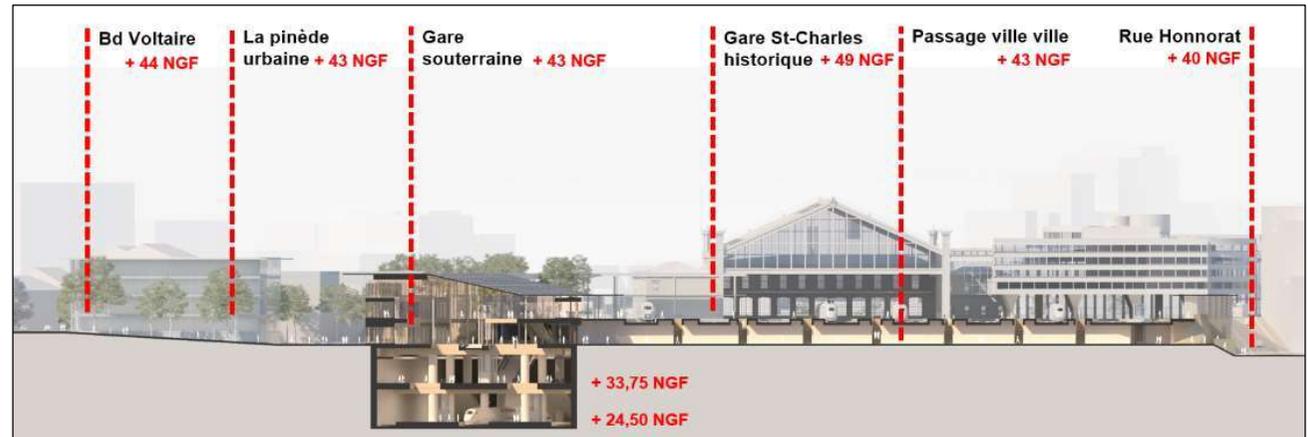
Coupe transversale sur le plateau ferroviaire - projet
